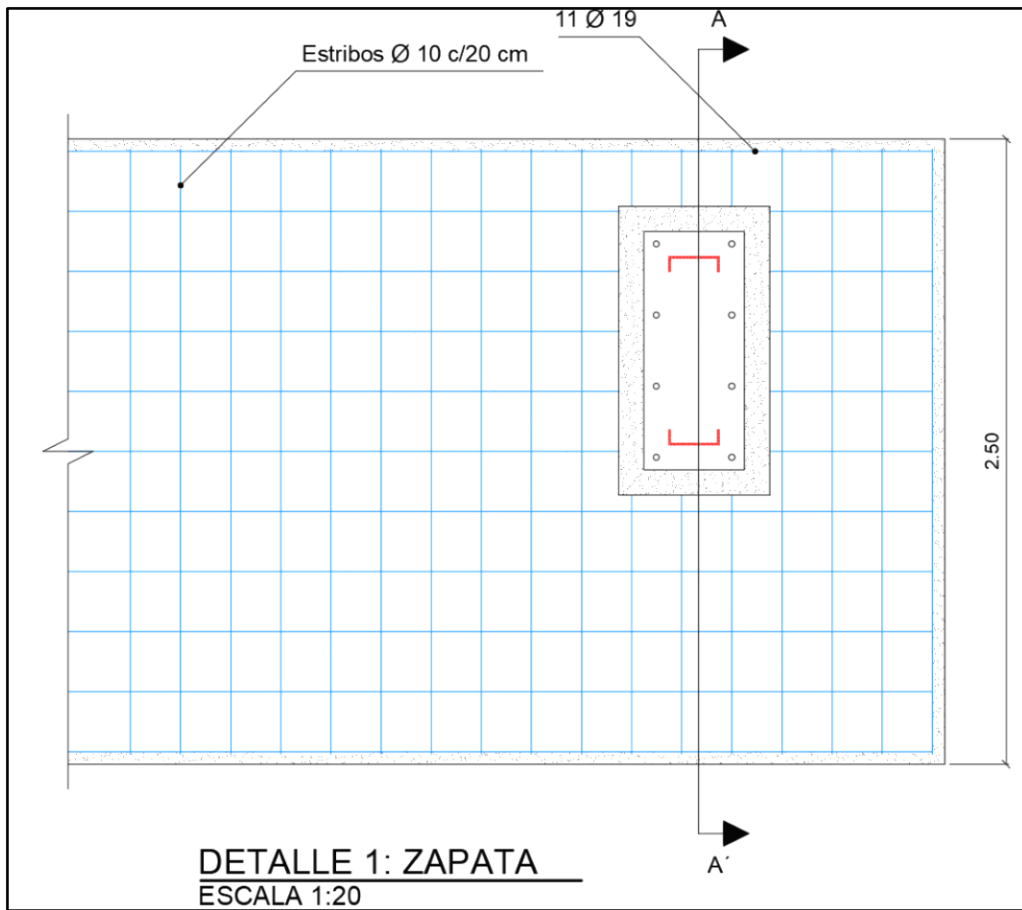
Dimensiones de la zapata [Pelayo & Ashby, 2020]
